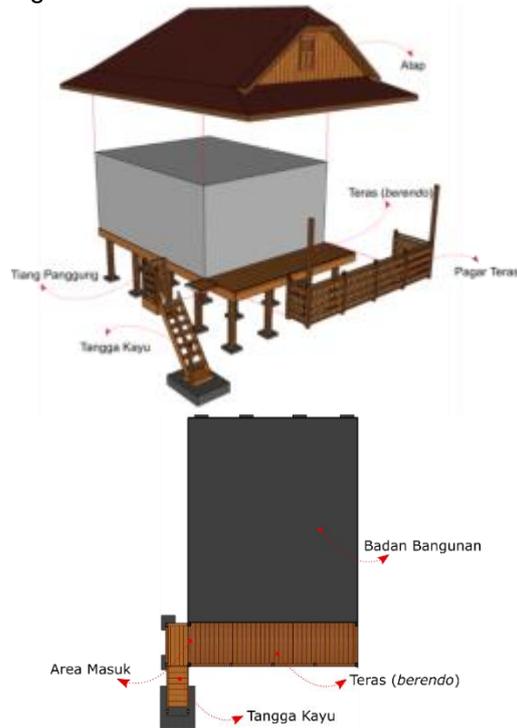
Isometri panggung kombinasi kayu dan beton tipe 4 (atas) dan denah panggung kombinasi kayu dan beton tipe 4 (Sumber: Analisa Pribadi, 2022)
